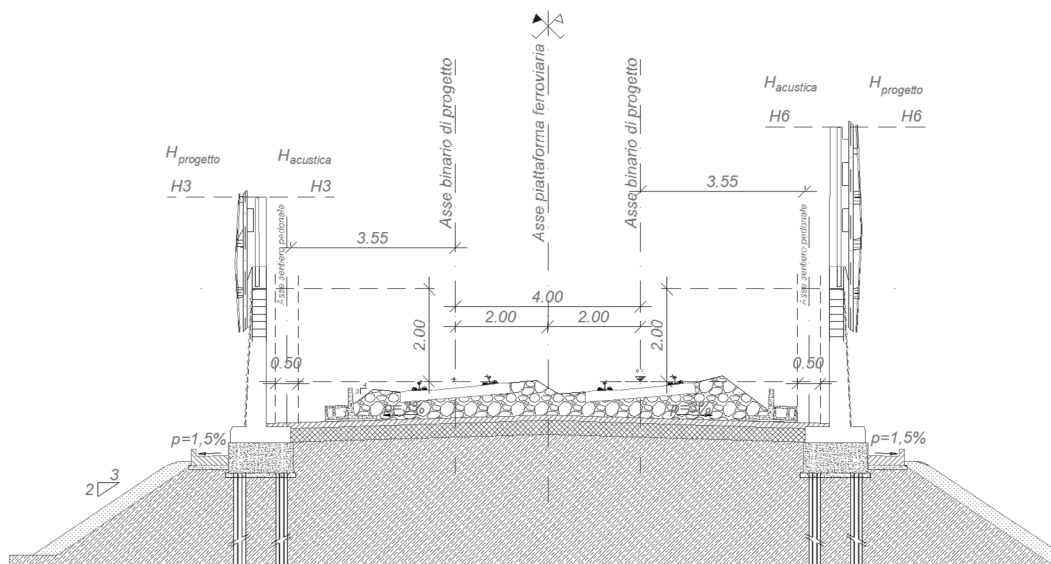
Sezione tipo tipologica BA "HS" rettificato con manufatto prefabbricato su rilevato
